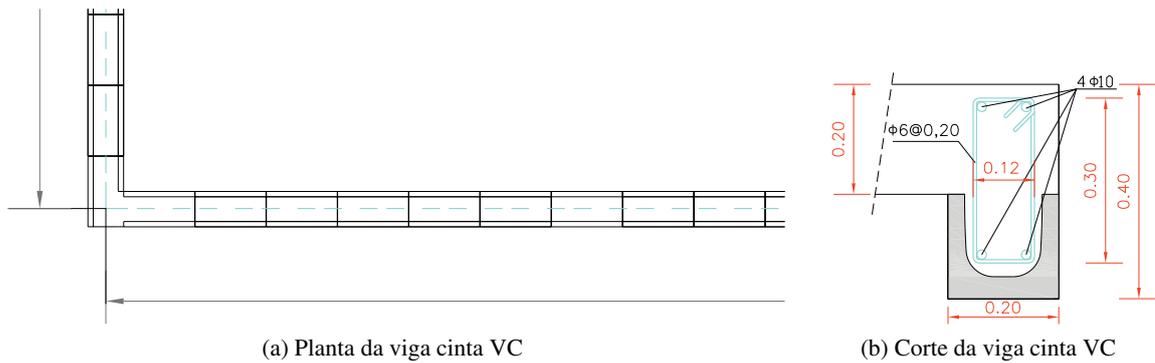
Pormenores de vigas cinto VC da solução em AE
